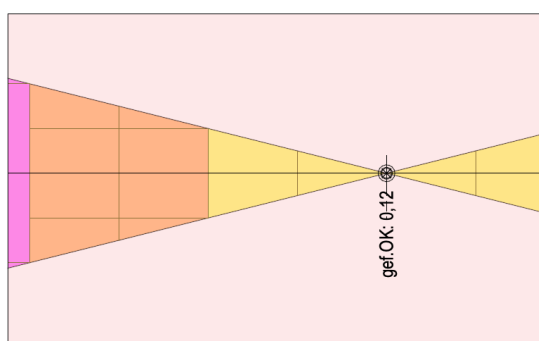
· Grundriss mit eingeschalteter LES-Darstellung: Die Keilreihen sind nach Dicke eingefärbt und an der Dachkontur beschnitten; im Tiefpunkt sitzt der Gully mit seiner Höhenkote.
